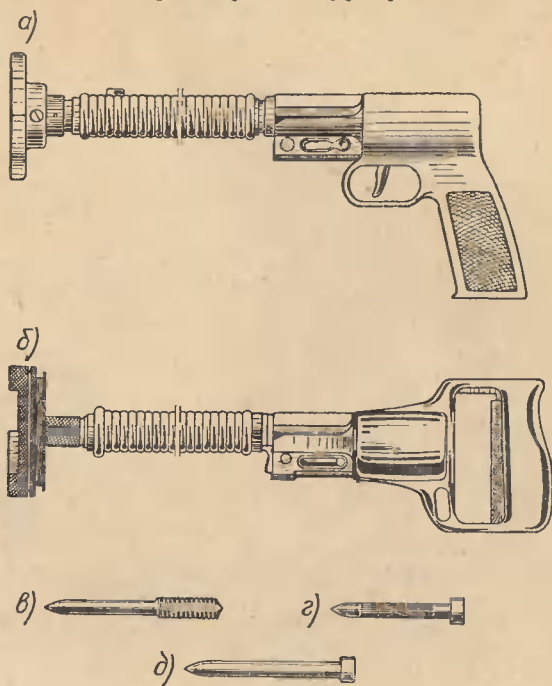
Строительно-монтажные пистолеты и дюбели к ним: а — строительно-монтажный пистолет СМП-1; б — строительно-монтажный пистолет СМП-3; в — дюбель-винт для съемного крепления электроизделий на бетонных и кирпичных основаниях; г — дюбель-гвоздь для глухого крепления электроизделий на металлических основаниях; д — дюбель-гвоздь для глухого крепления электроизделий на бетонных и кирпичных основаниях.
